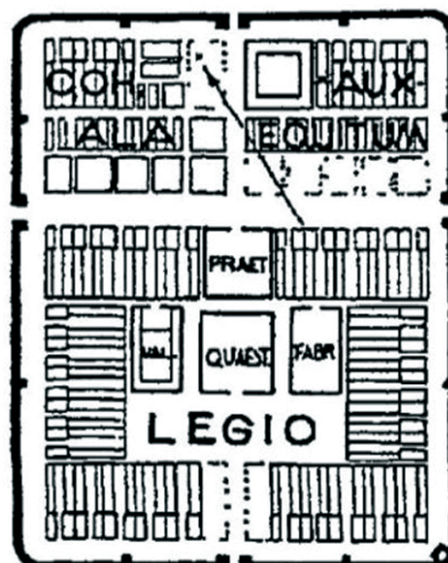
Planta típica de um *castrum* romano. (Zucker, 1959, p. 46).
